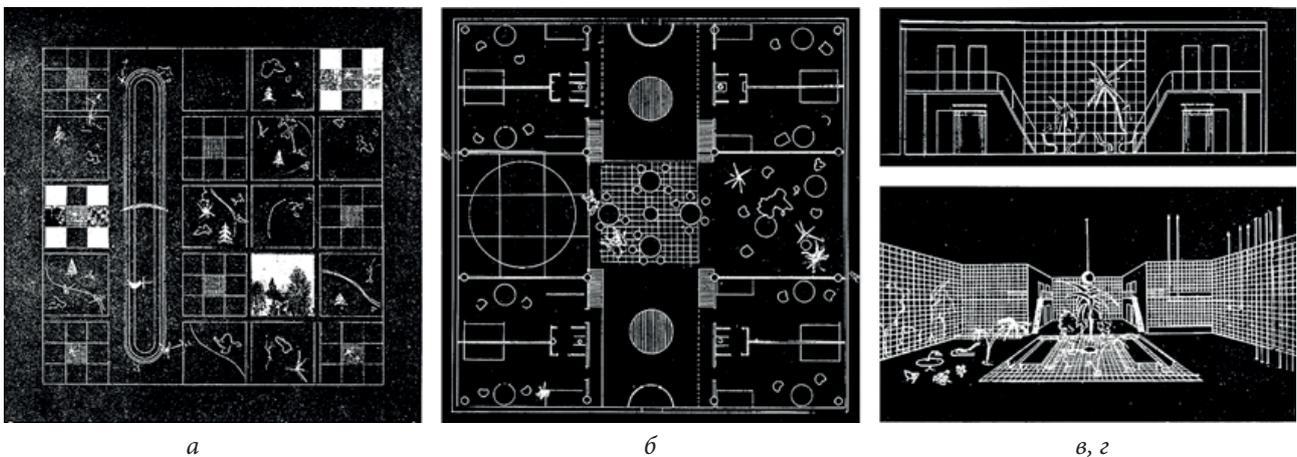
Концепция жилого квартала для Магнитогорска: а – схема планировки квартала, б – схема плана жилого дома, в – разрез жилого дома, г – интерьер жилого дома (бригада ОСА) [34]
